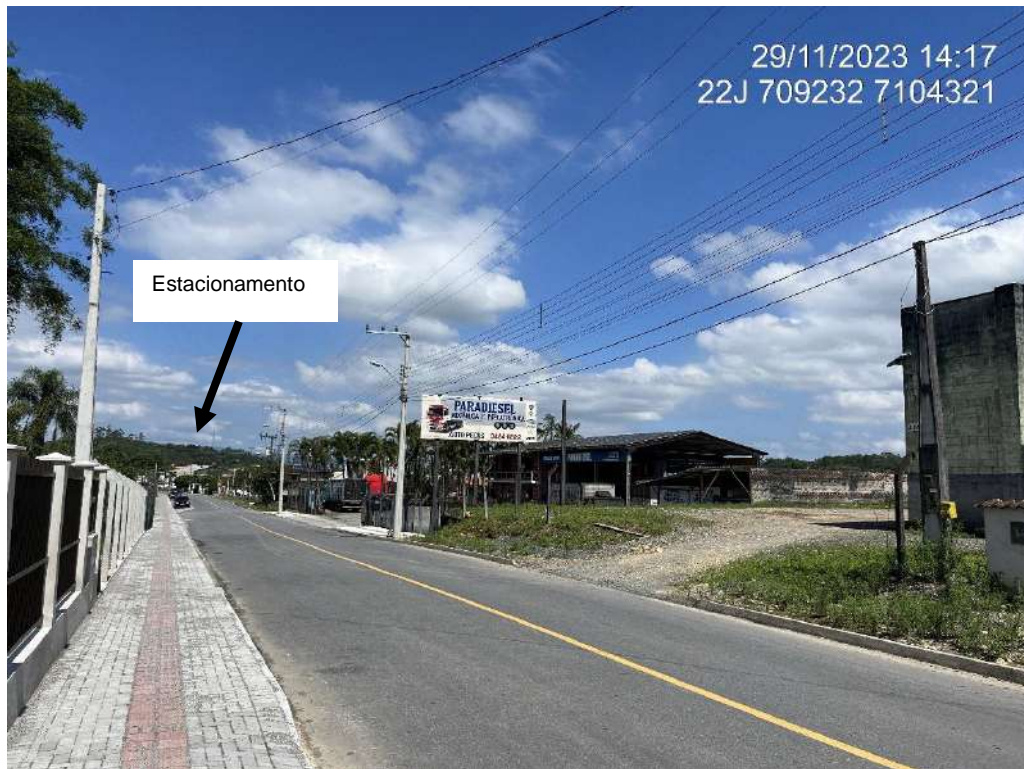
Final da rua Bernardo Schneider, vista para rua XV de Outubro, em trecho sem estacionamento.
